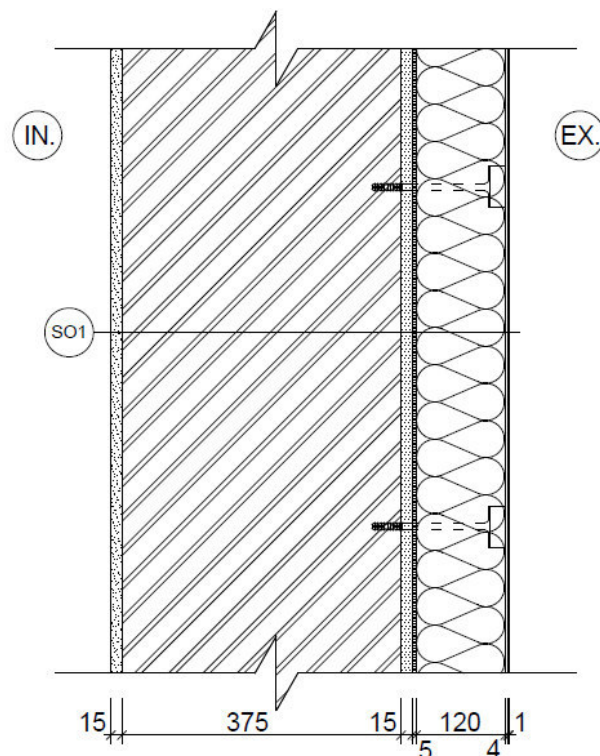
Skladba konstrukce zatepleného obvodového pláště, varianta č. 1 (autor)
